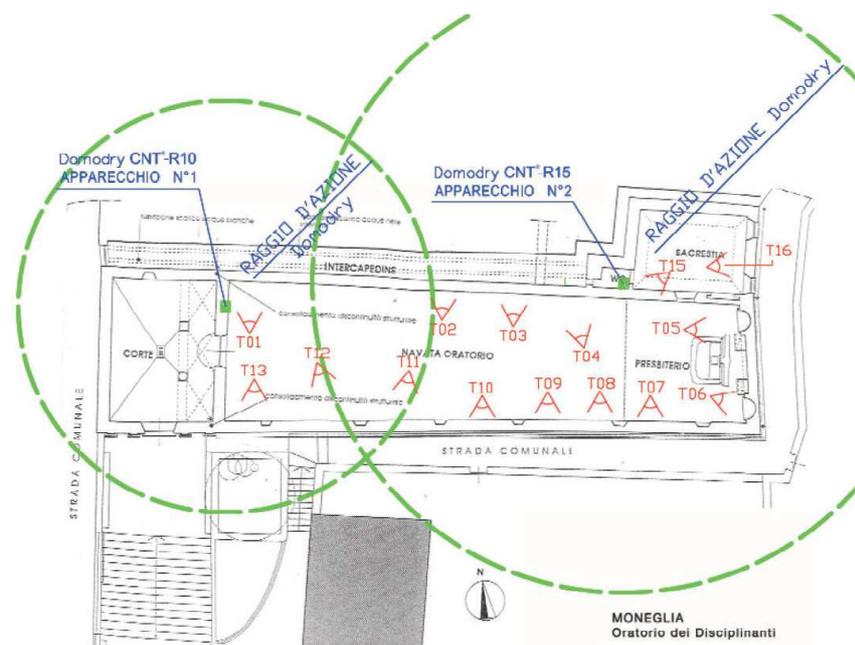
Schema planimetrico dei dispositivi CNT installati nell'ottobre 2011
